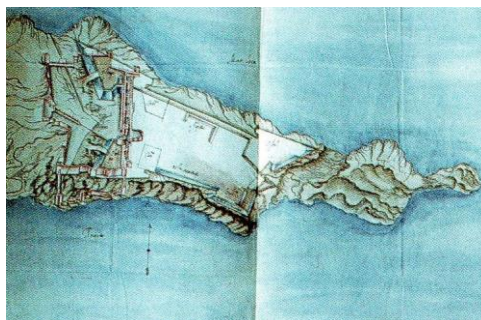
Planta de Juan Bautista Antonelli (ADA. Planos-28).
